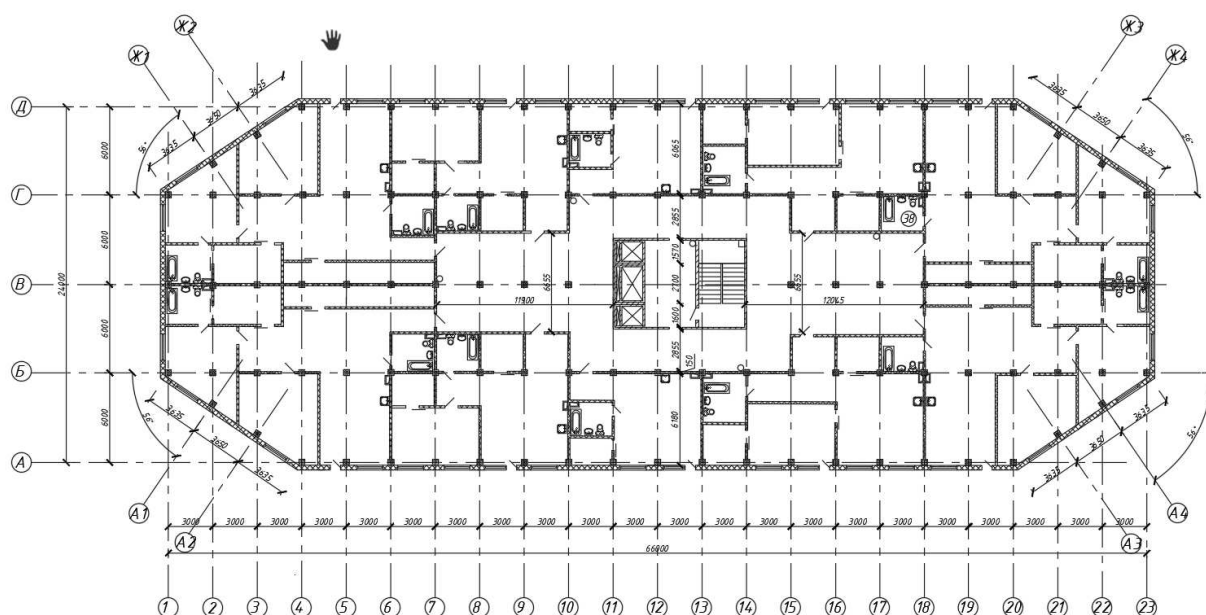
Конструктивная схема здания (вариант 1)
